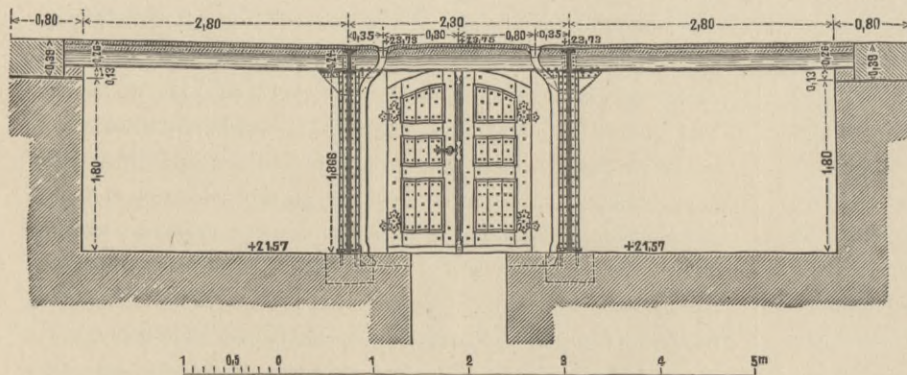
Querschnitt durch die Maschinenkammern im Außen- und Binnenhaupt der Schleusen-Mittelmauer in Holtenau.
